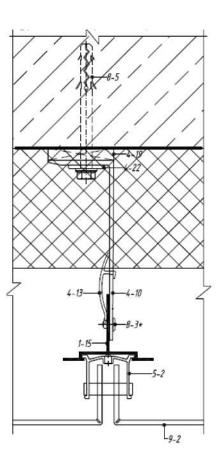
Горизонтальный разрез навесной фасадной системы (на примере U-kon) для п. (1)
